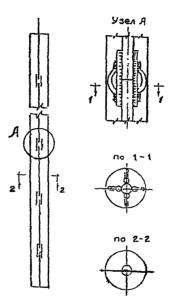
Возможный вариант армирования буроинъекционных свай, воспринимающих нагрузку до 200 кН
